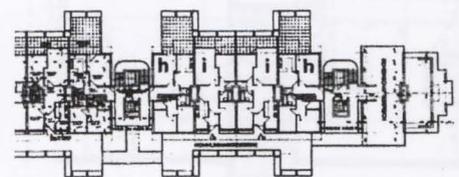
Lageplan Terrassenhaussiedlung, 1972-78
